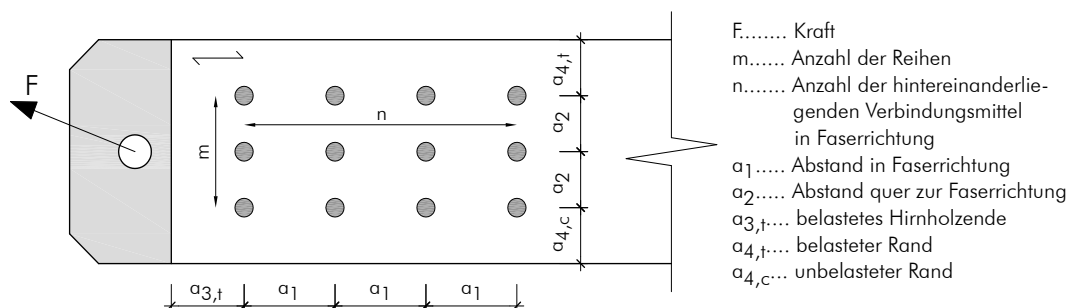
Randabstände und Definition von m und n am Beispiel einer zweischnittigen Stabdübel-Verbindung mit innenliegendem Stahlblech
